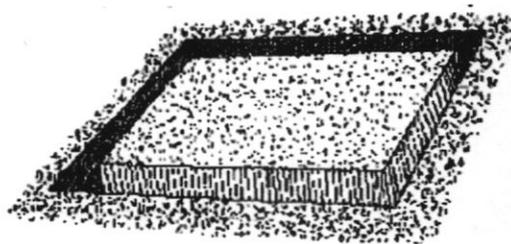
Zanjado para la construcción de pared de adobe.
